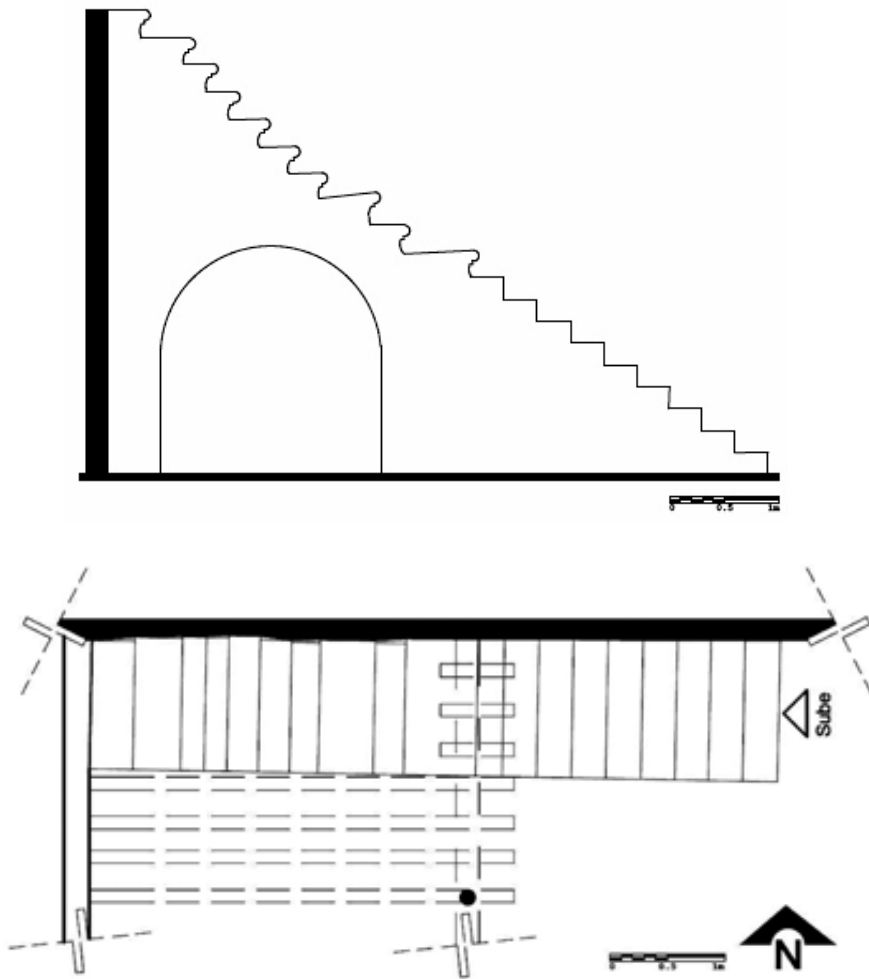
y 24. Alzado y planta de la escalera construida por José María Llerena para su estudio ubicado en el Mesón. (Esta escalera fue desmantelada en septiembre de 2007).
